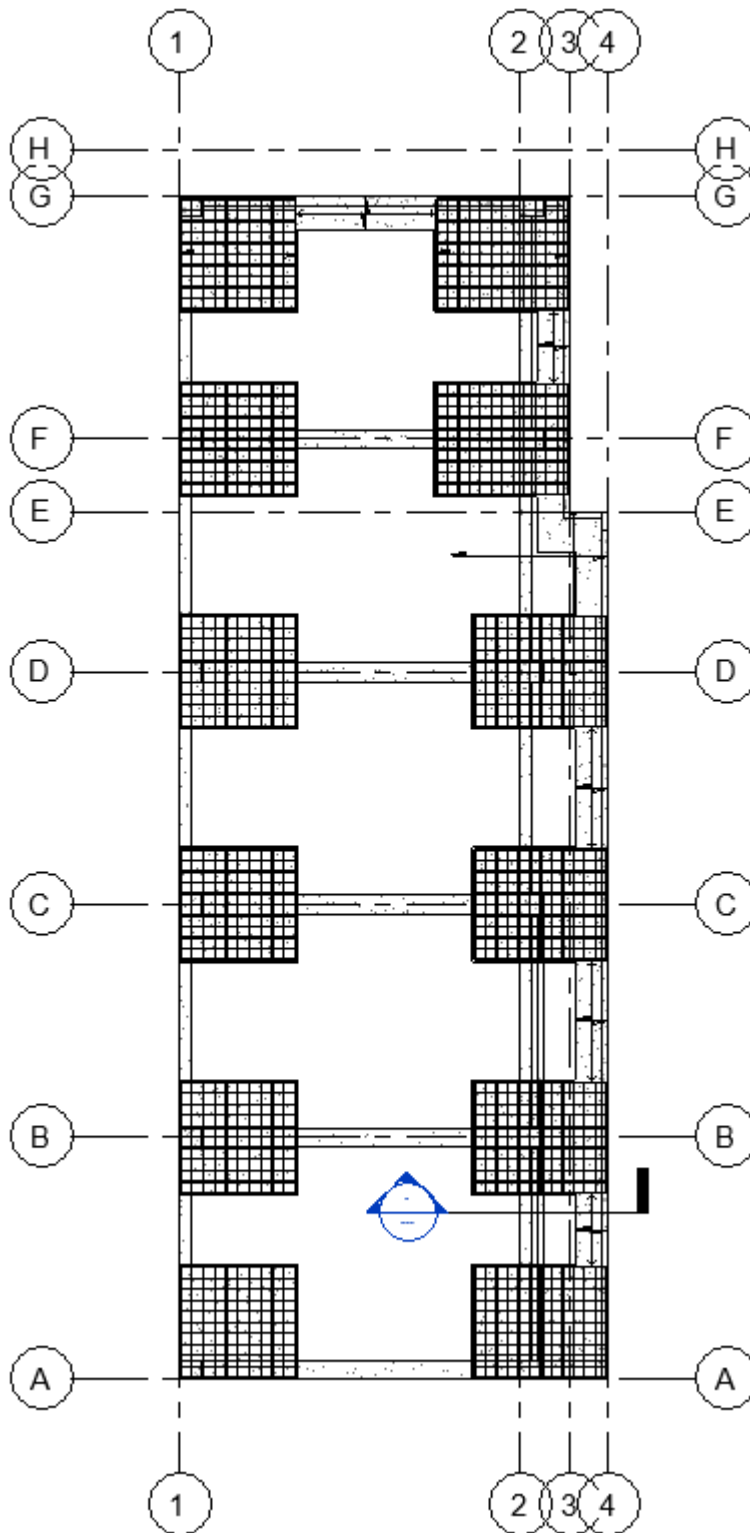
Vista de Planta 1er nivel, se observa el detalle del enmallado de acero en Zapatas (Fuente: Elaboración Propia).
